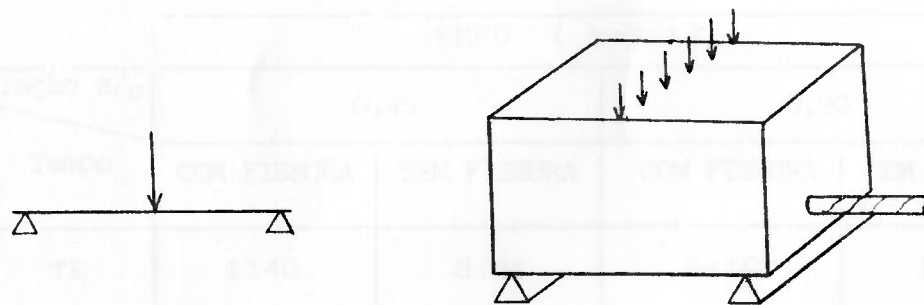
Mecanismo para obtenção da fissura transversal à barra da armadura.
